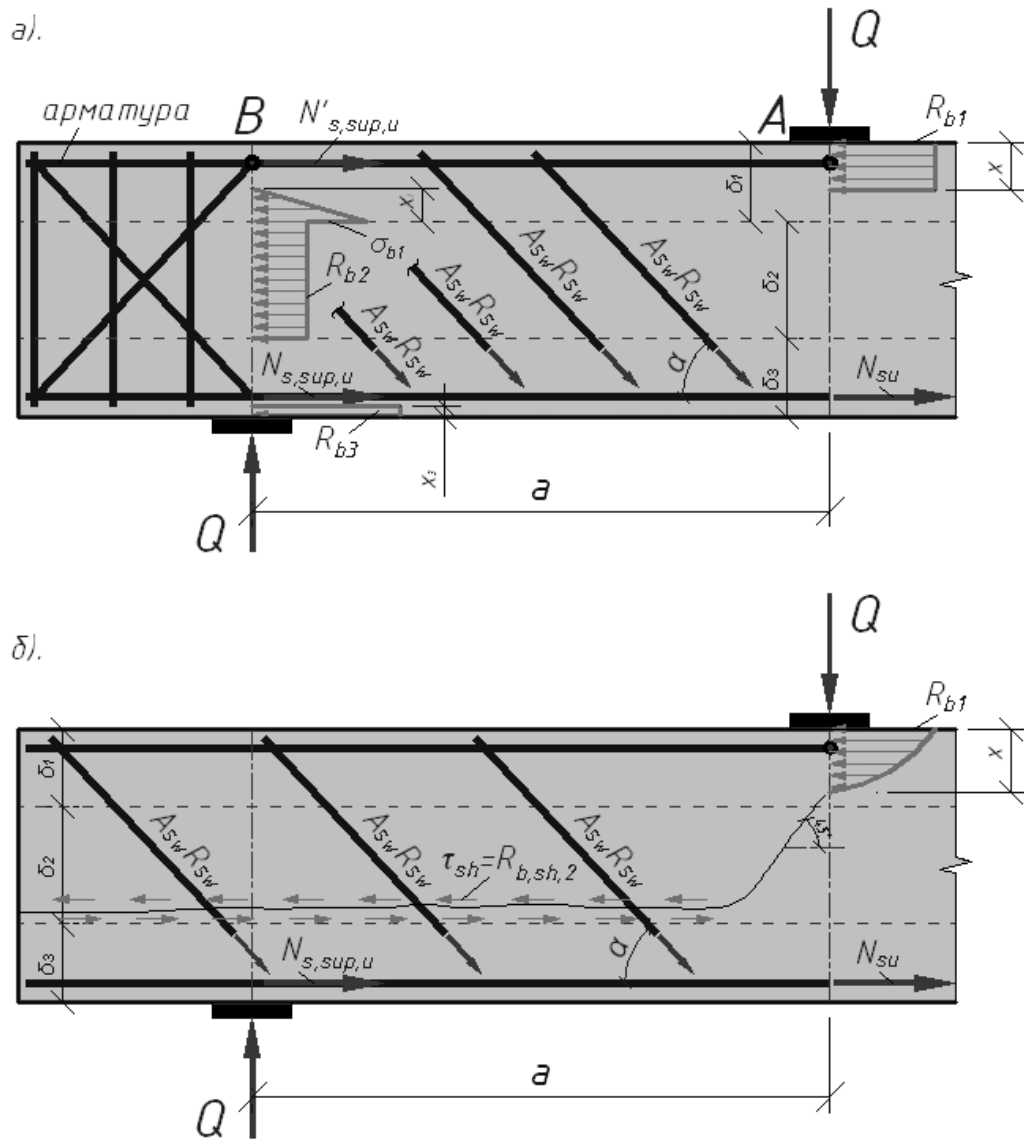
Расчётные схемы действующих усилий на приопорном участке трёхслойного железобетонного элемента: а - при достаточно надёжной анкеровке рабочей арматуры; б - без анкеровки.
